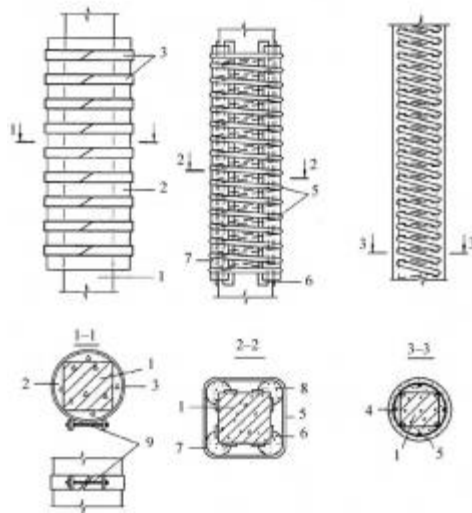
Підсилення стиснених елементів влаштуванням дотичної арматури: а – кільцевої арматури; б, в – спіральної арматури; 1 – підсилювана колона; 2 – додатковий бетонний елемент; 3 – кільцева арматура; 4 – додаткова стиснена арматура; 5 – спіральна арматура; 6 – пластина; 7 – додатковий сталевий елемент; 8 – бетон на самонапружувальному цементі; 9 – стяжка
